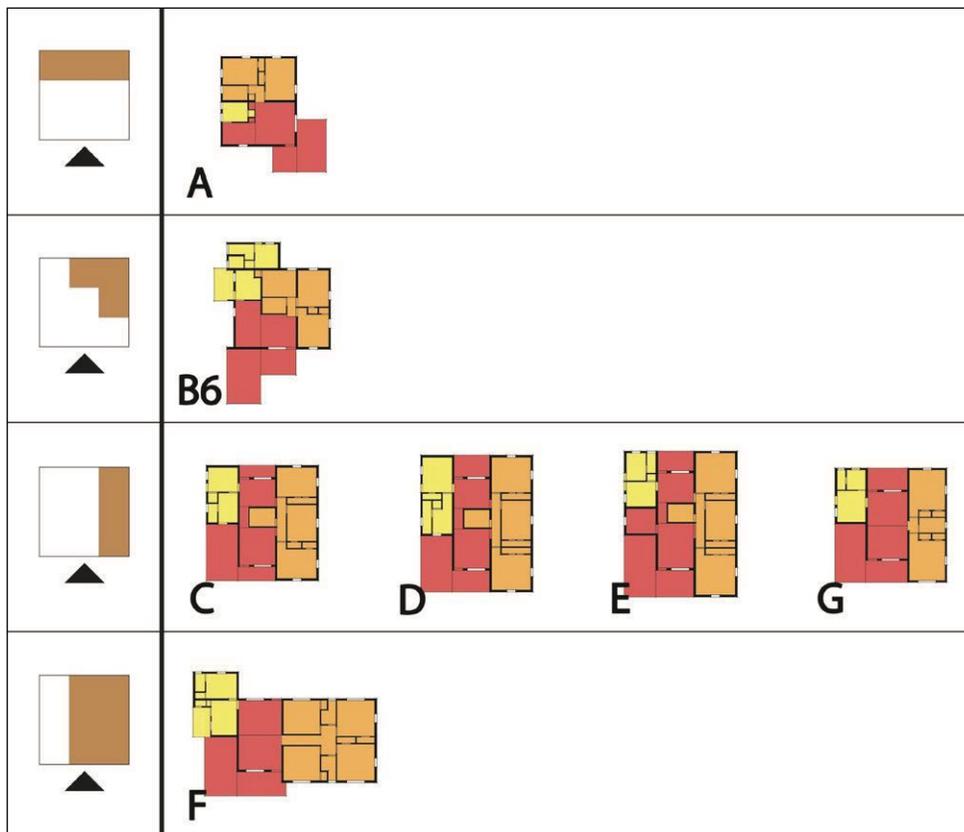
Clasificación tipológica de los modelos de viviendas según la distribución de los dormitorios en la planta física. Fuente: Autora.
